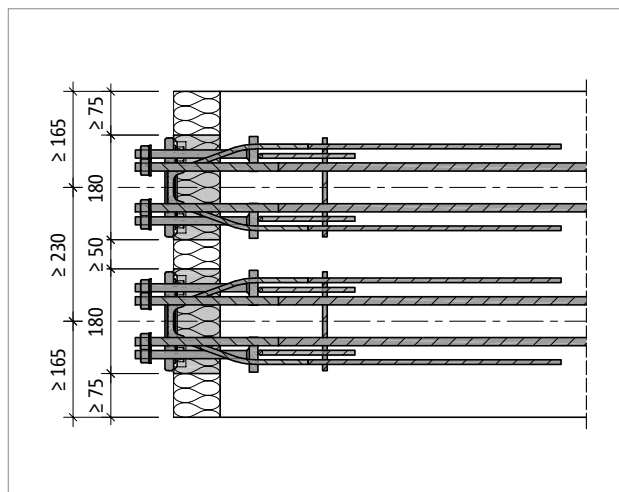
Schöck Isokorb® T type SK : espacement axial
